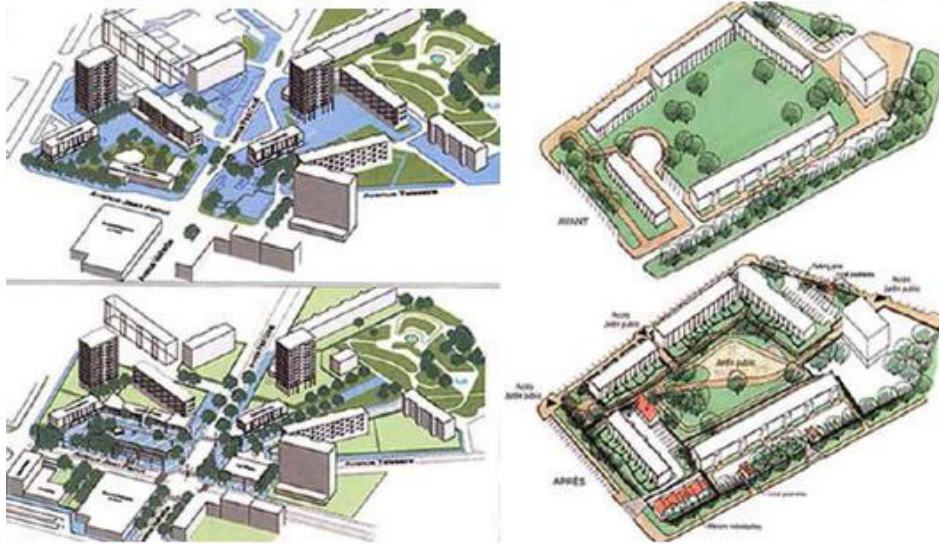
La relazione davanti|dietro: prima e dopo il progetto sulle facciate
